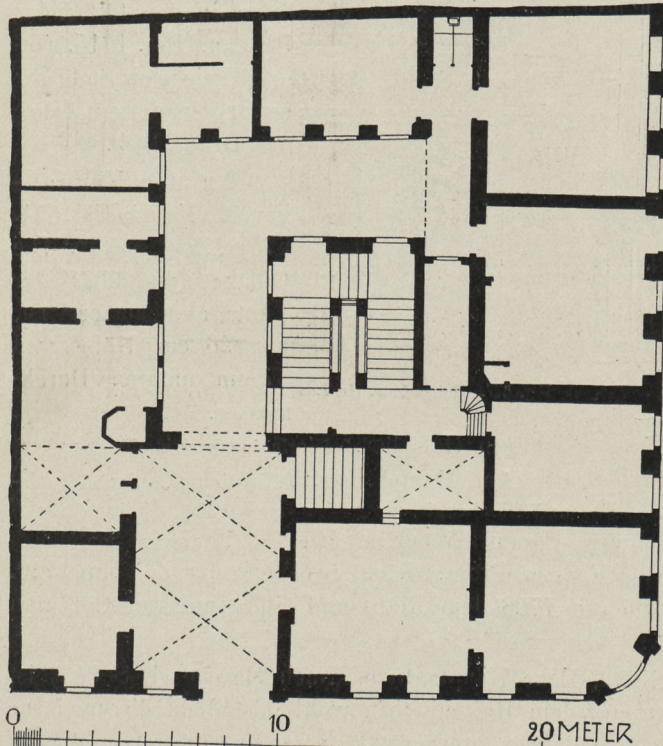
Kleine Brüdergasse Nr. 21. Grundriss des Erdgeschosses.
